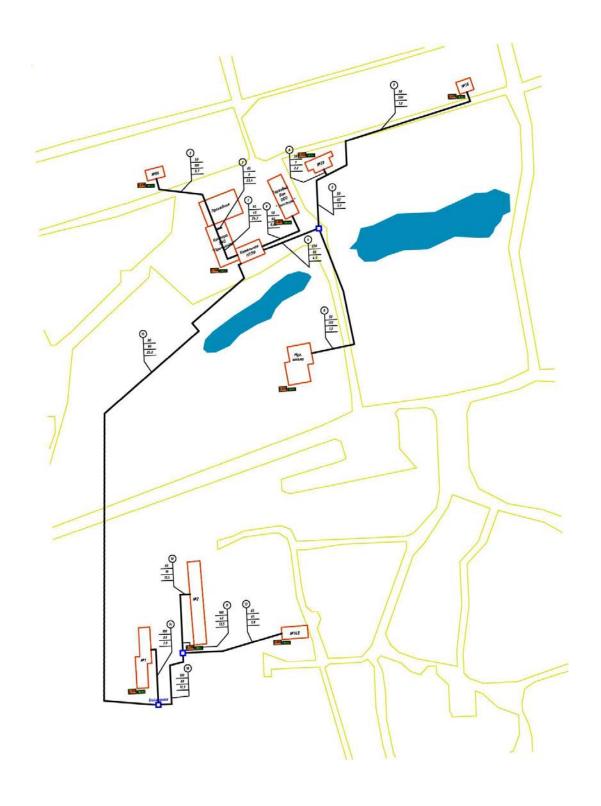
Схема сравнения расчётных и фактических тепловых нагрузок по котельной 3 НПТ Φ
